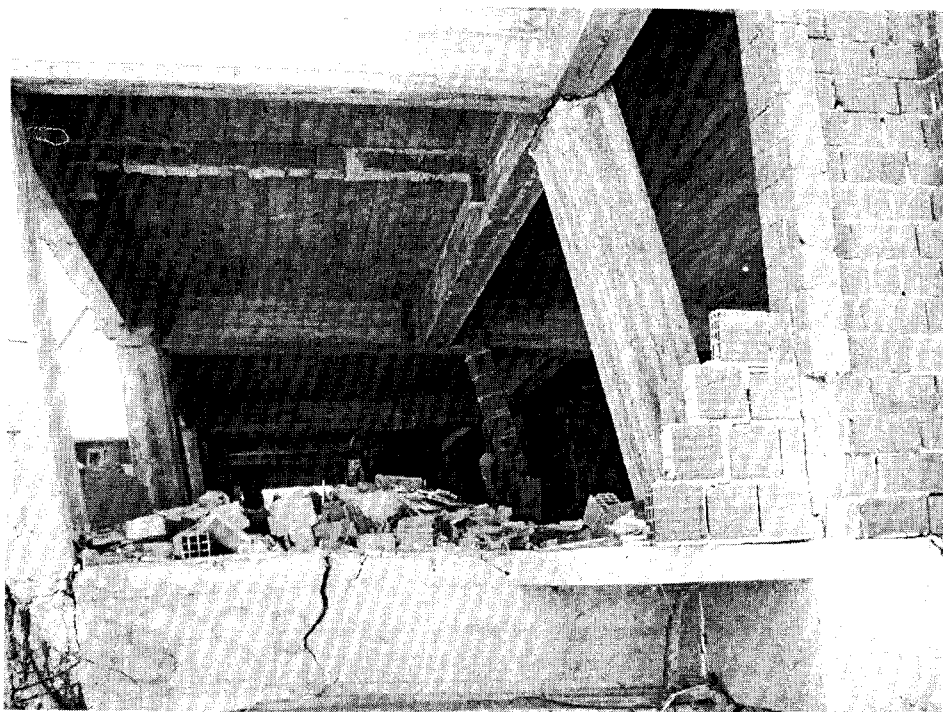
Edificio en construcción con rótulas plásticas y mecanismos de colapso.
